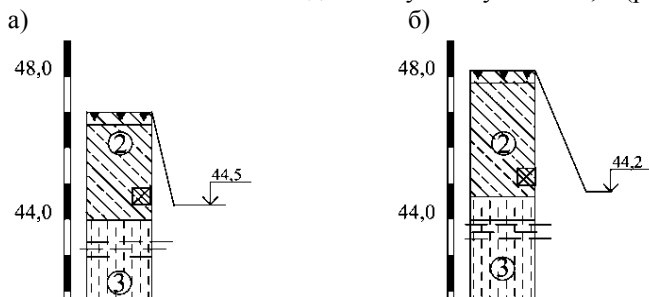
Схемы отбора монолитов грунтов для лабораторных исследований: ■- места отбора монолитов; а) площадка №1; б) площадка №2
